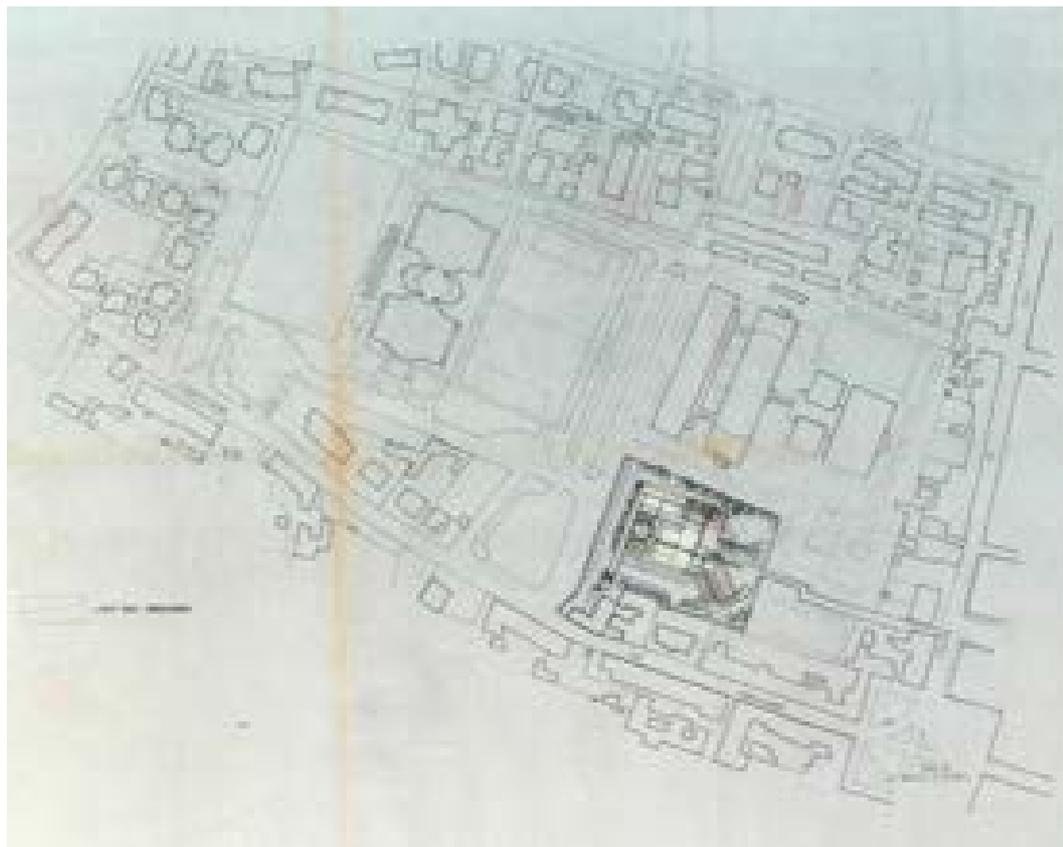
Planimetria, stato sovrapposto – 26/07/1994 (AABS-64_696)
